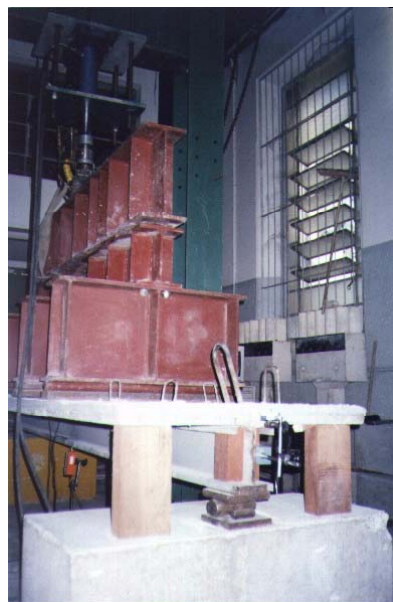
Detalhe do sistema de ensaio viga mista "I enrijecido" (modelos 3 e 4).
